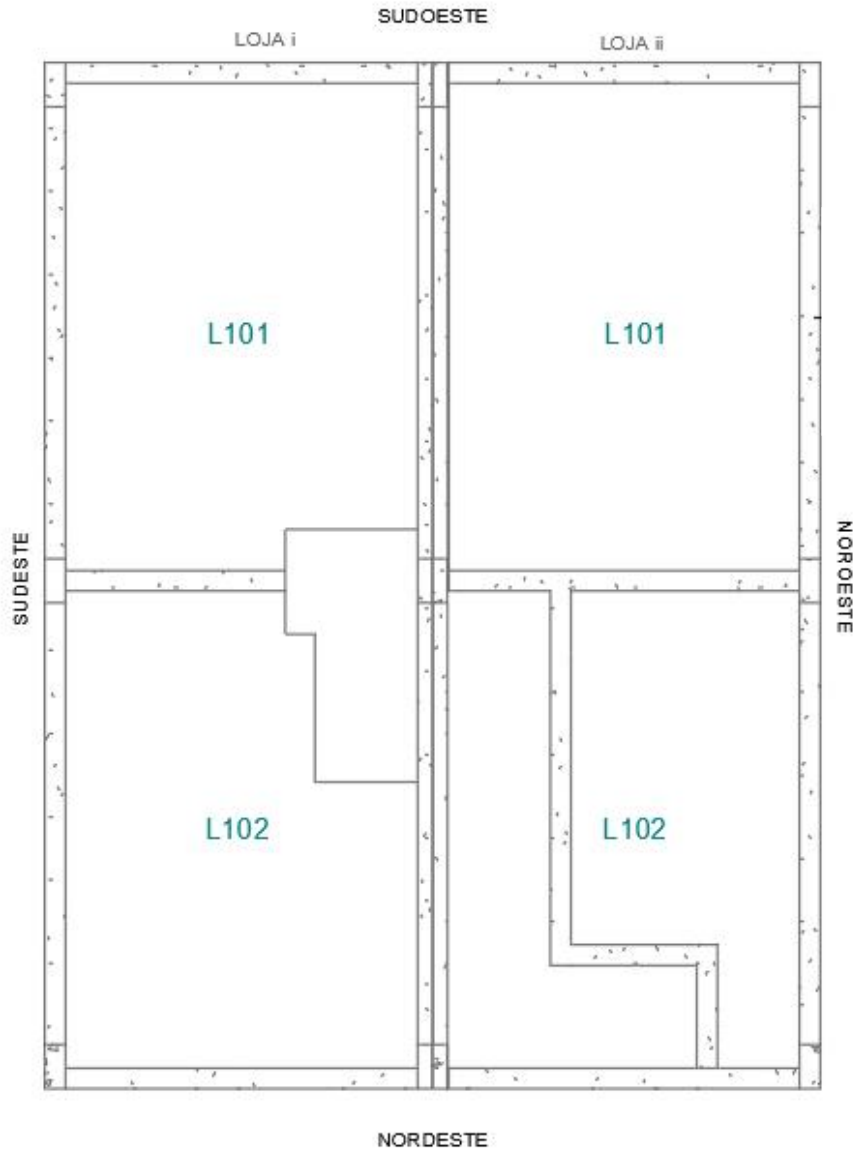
Planta Baixa com nomeação das Lajes – Nível 200 (Cobertura).
